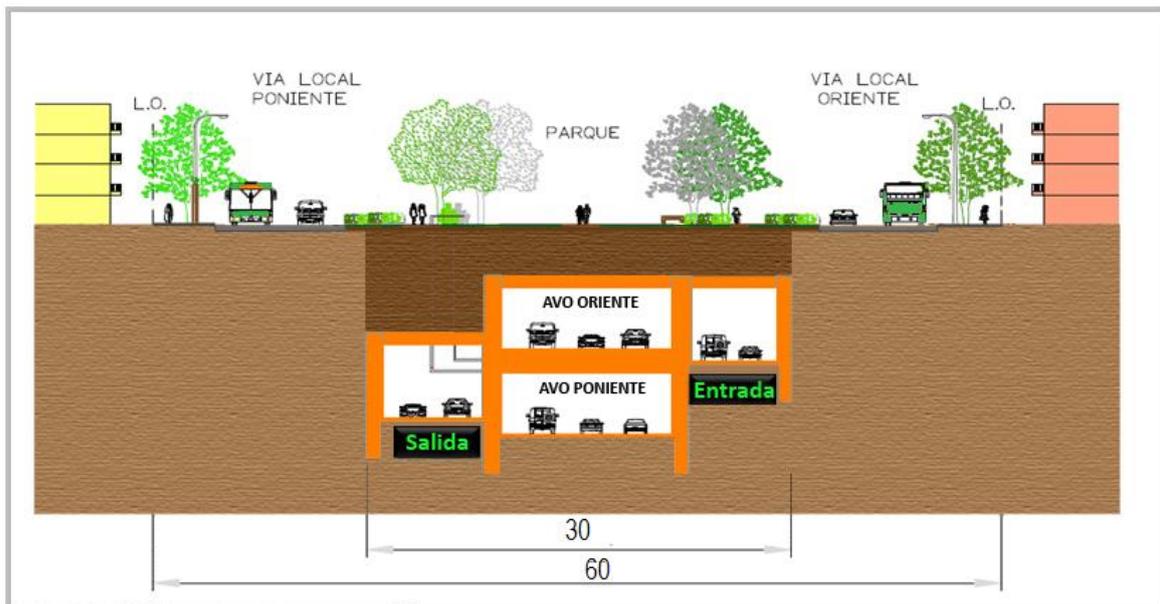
Trincheras Cubiertas Simples Adosadas a la Trinchera Cubierta en dos niveles
